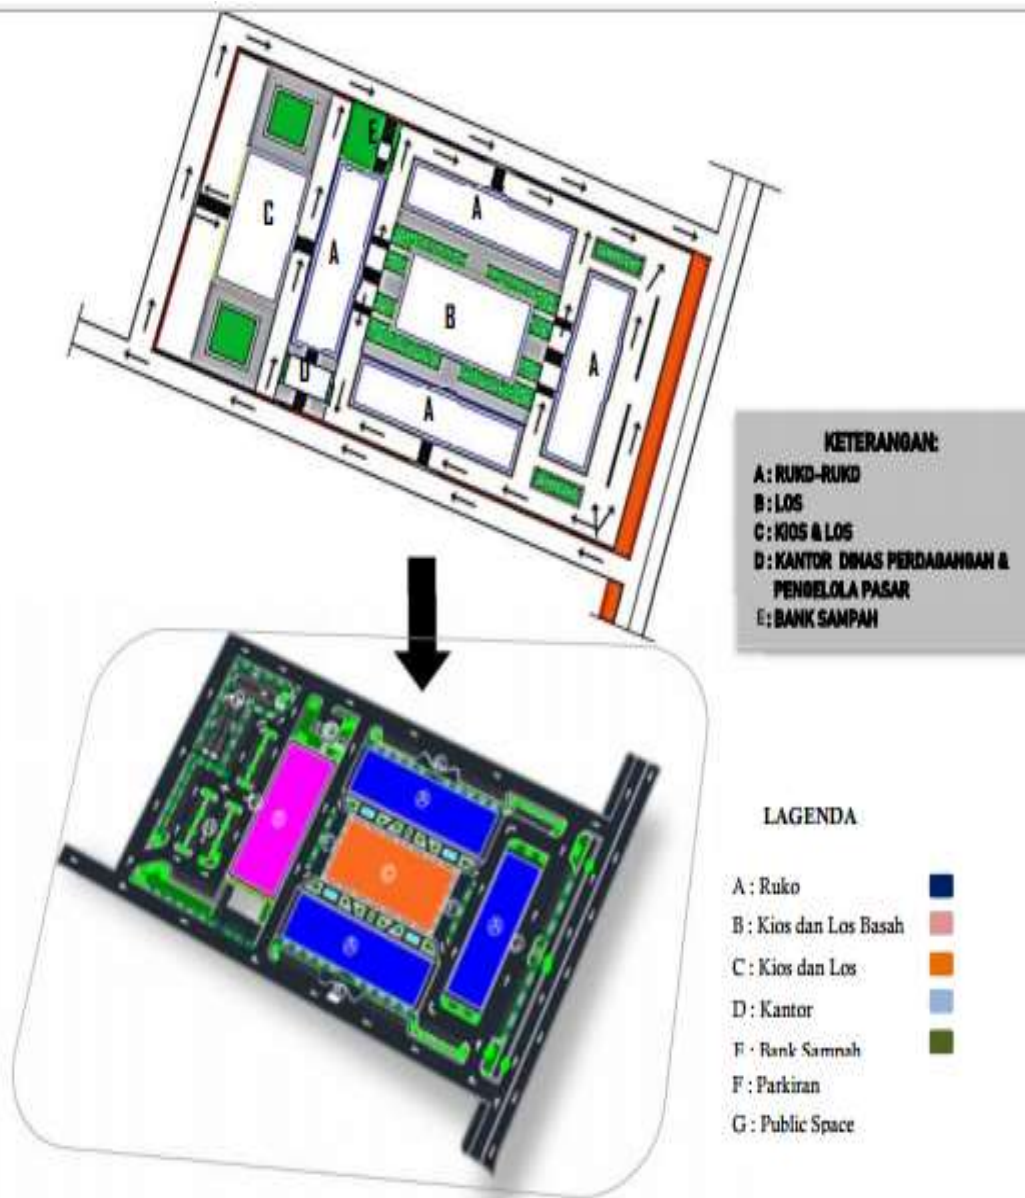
Sintesa Zoning Ruang dan Tapak Pada Site Plan Pasar Sentral Takalar
